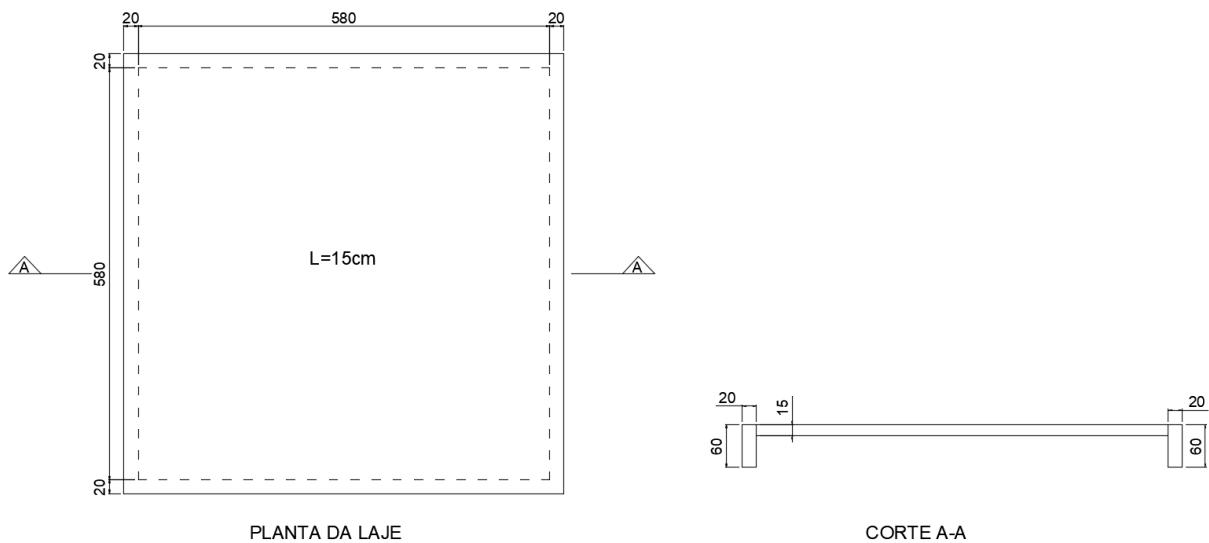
Croqui de forma do modelo de laje e vigas adotado.
